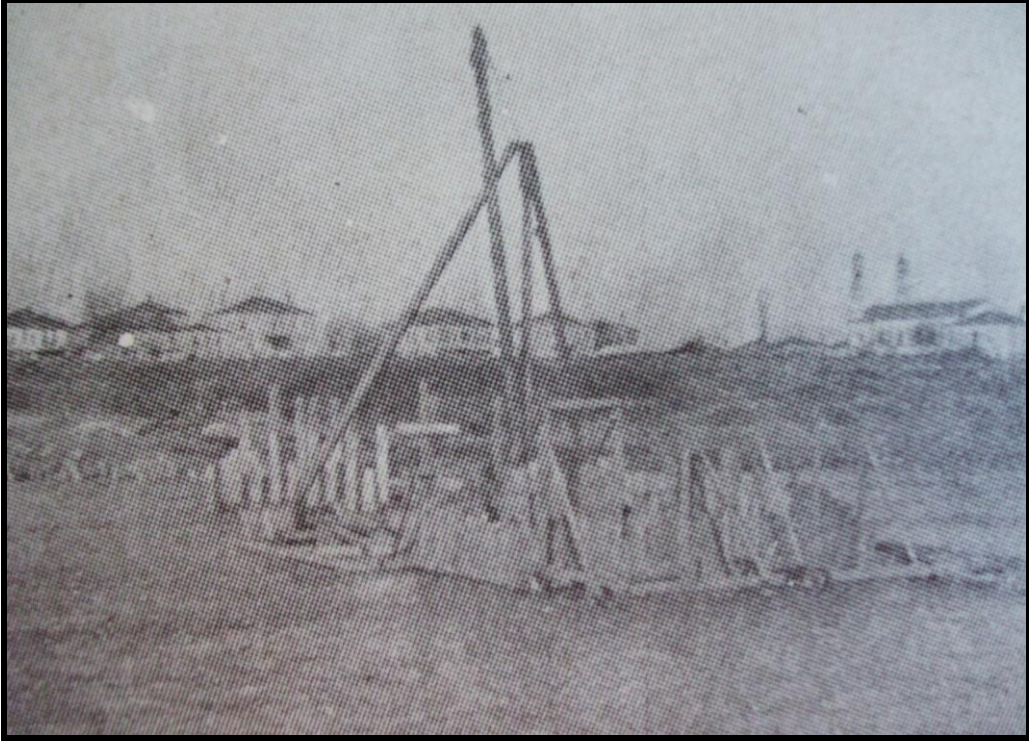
Betonarme köprünün temel inşaatından bir görünüm (Anonim).
